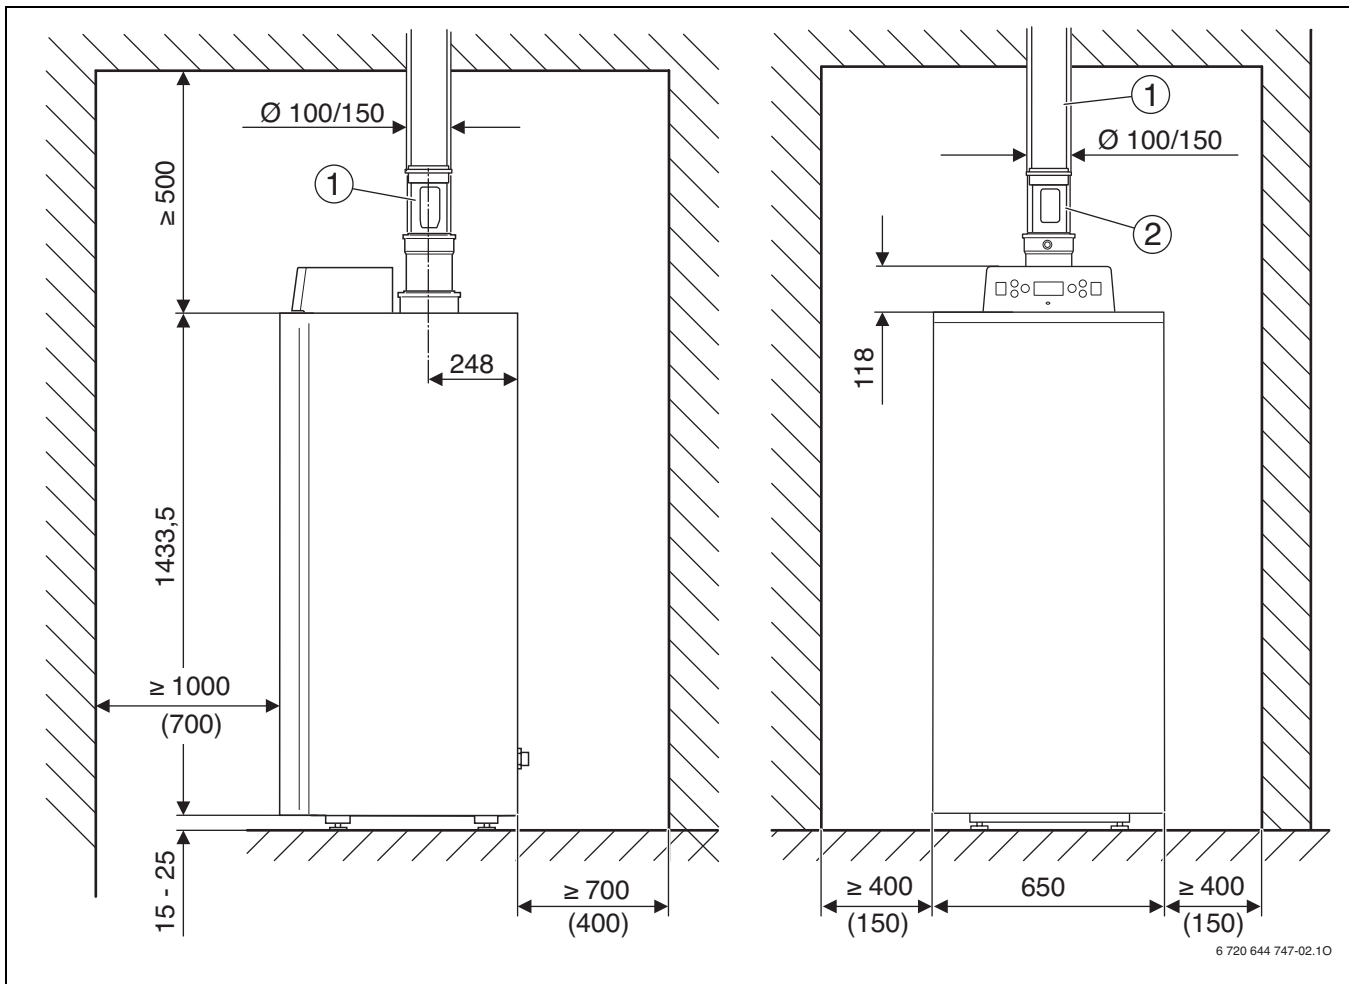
Einbaumaße bei senkrechter Abgasführung (die in Klammern angegebenen Werte sind Mindestmaße)
